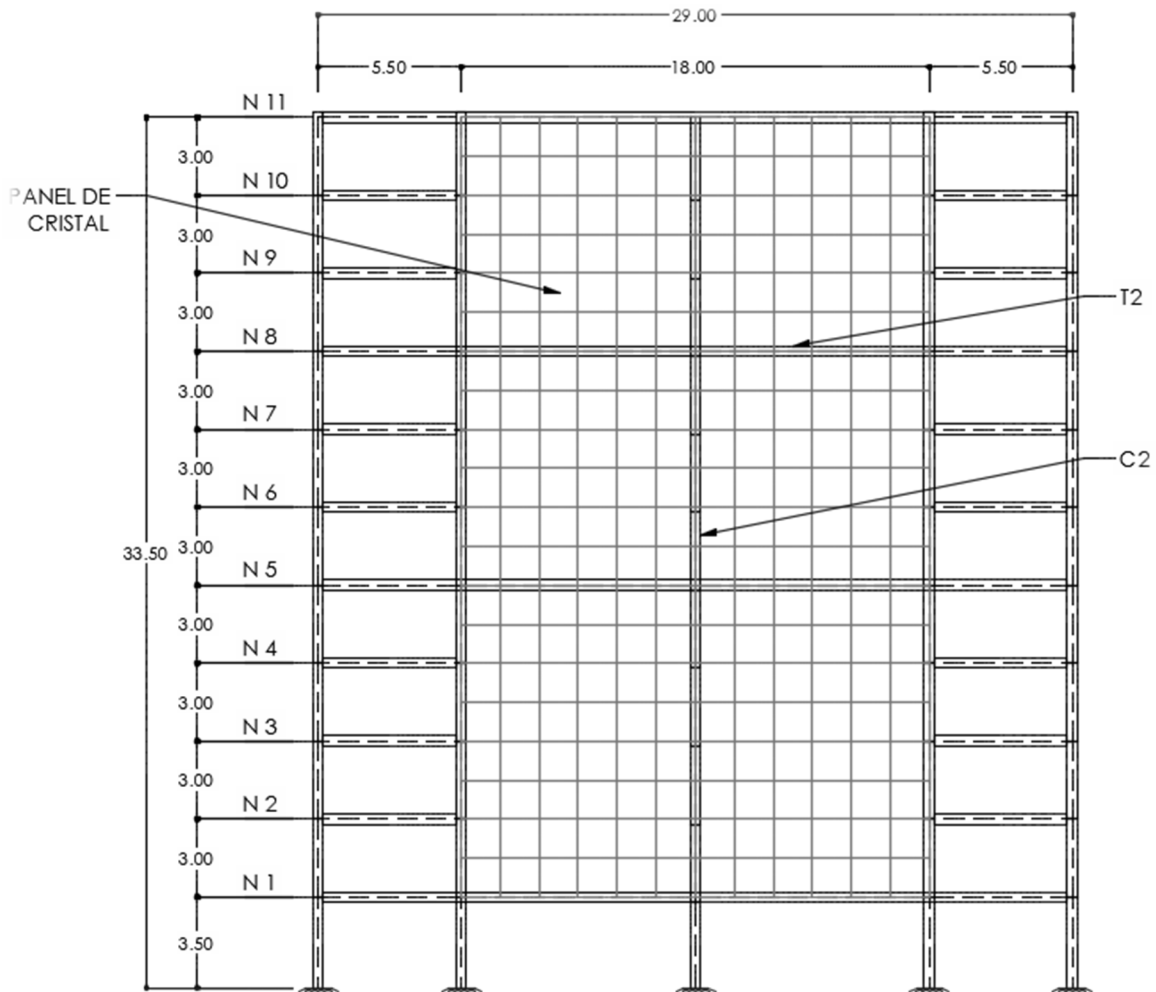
Distribución de paneles para fachada acristalada propuesta
